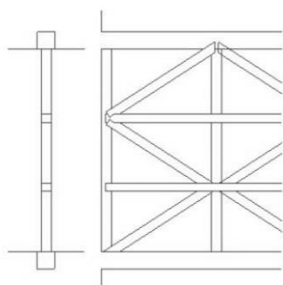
Pormenor construtivo de um frontal tecido (Ramos, 2009).
